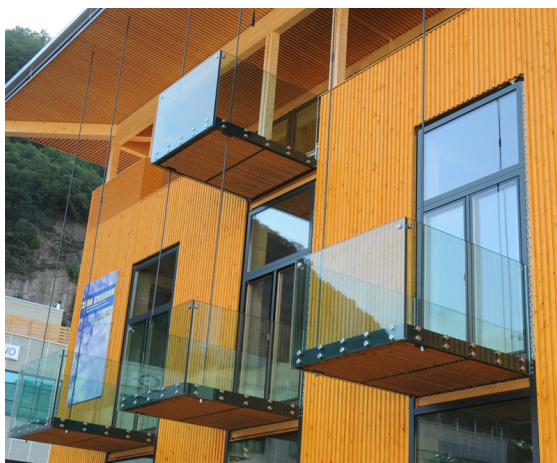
Vista prospetto est; Fonte: C. dal Vero, 2008;
